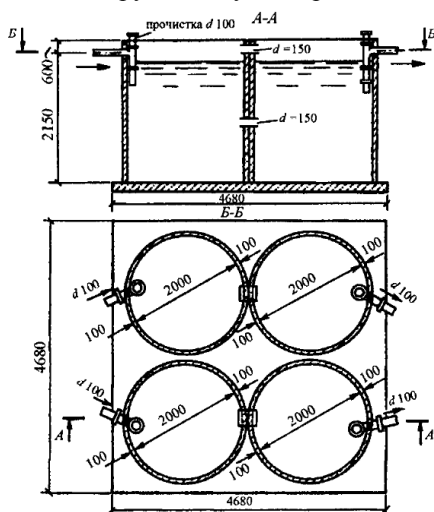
Двухкамерный септик из железобетонных колец
